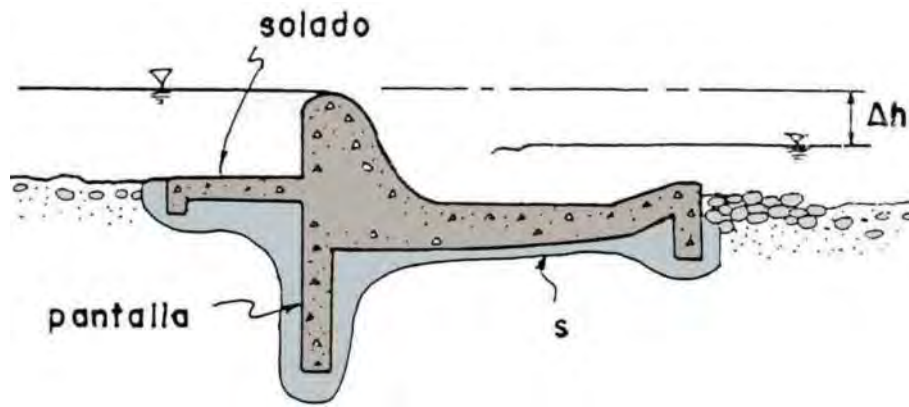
Esquema de pantalla impermeable y dentellón en barraje vertedero fijo. (Mansen, 2006)
